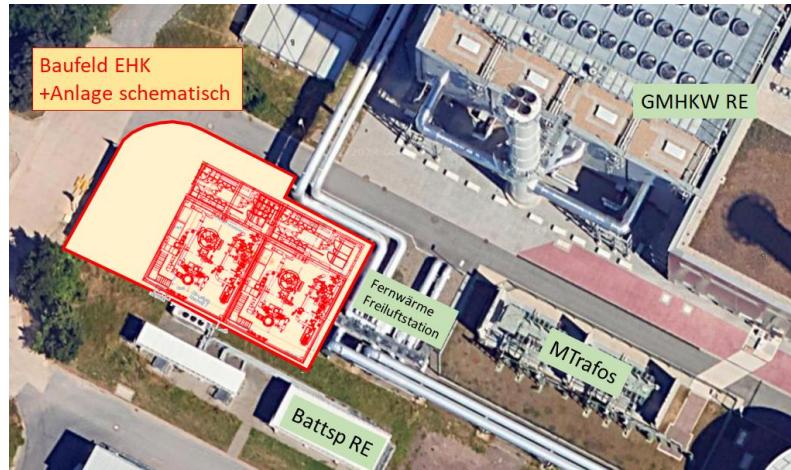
Luftbild mit Lageplan Baufeld und schematischem Gebäudeentwurf
